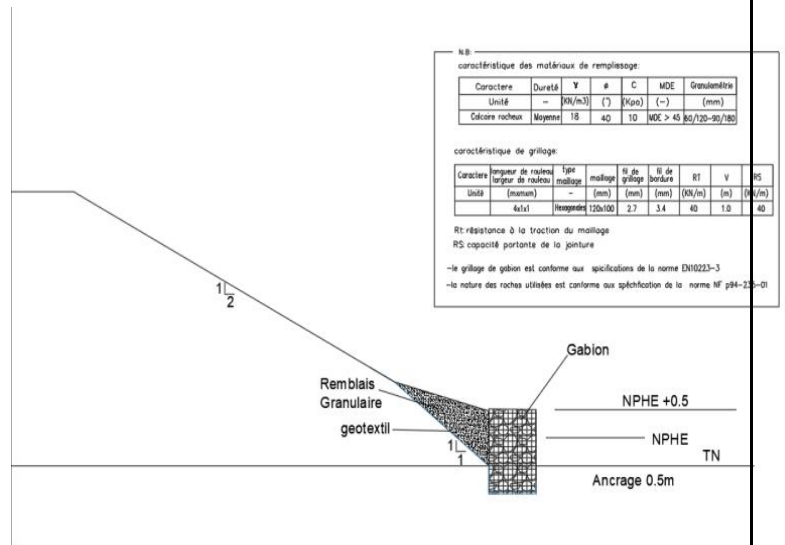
COUPE TRANSVERSAL POUR GABION
